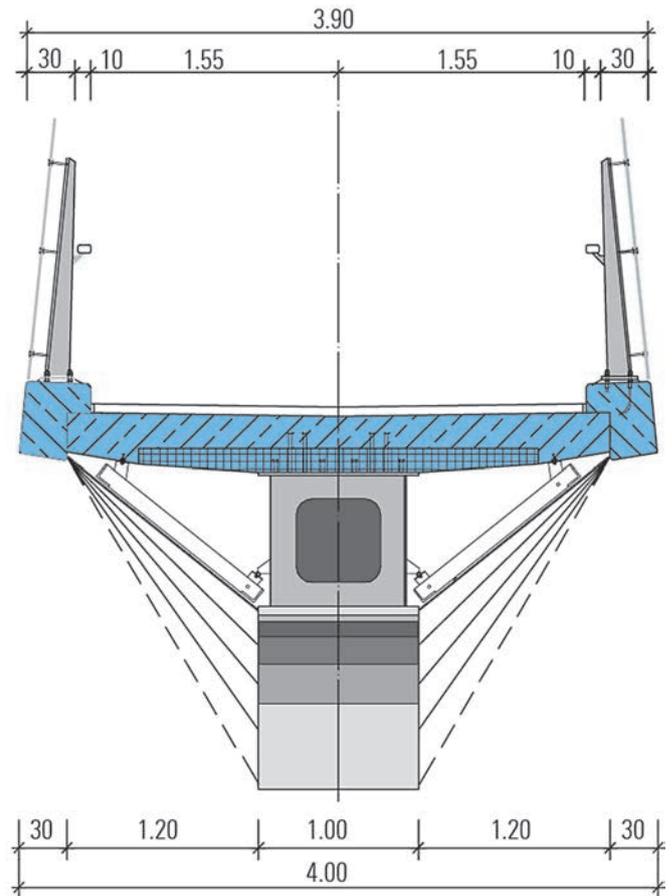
Regelquerschnitt Passarela – Hauptbrücke in VFT-Bauweise mit dichtgeschweißtem Hohlkasten
